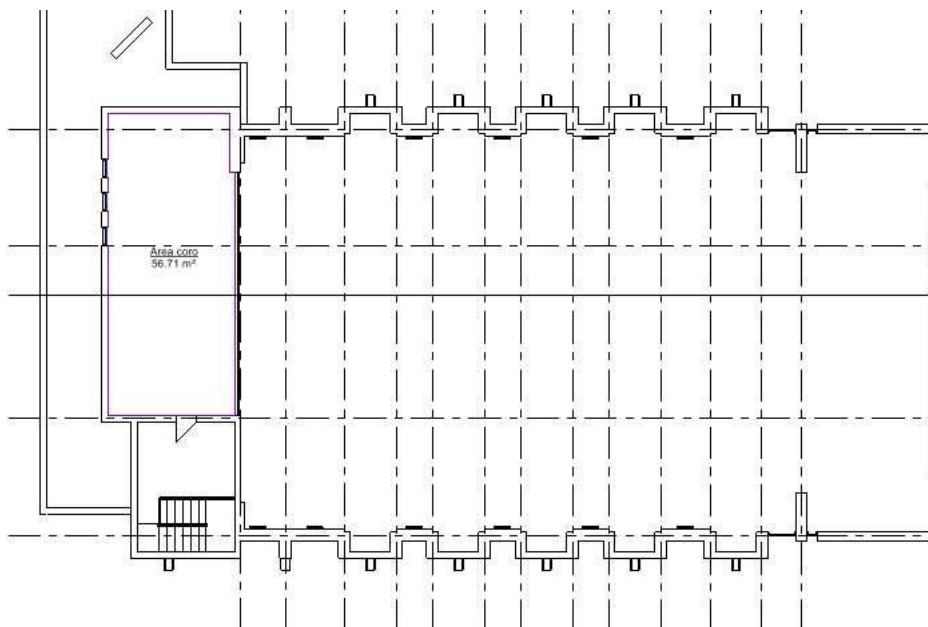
Imagen Revit distribución de espacios en planta nivel CORO
